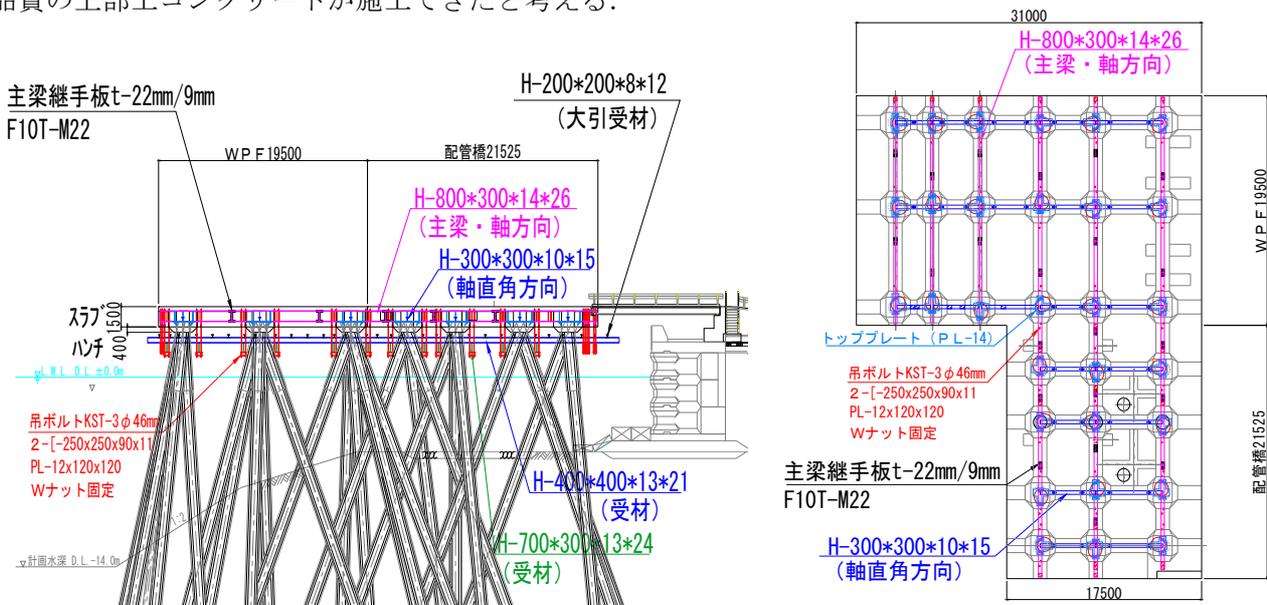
吊支保工主梁配置計画図 (断面・平面躯体内)
